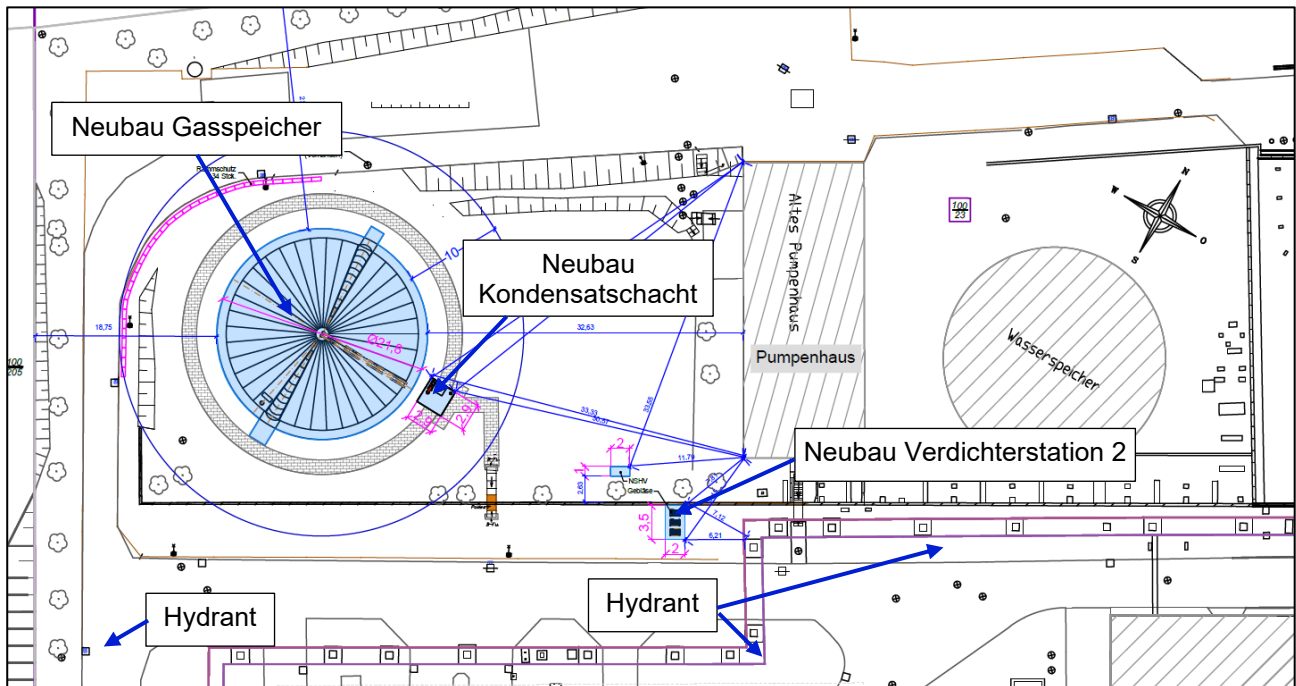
Aufstellplan der geplanten baulichen Anlagen mit Bemaßung von relevanten Abständen, Quelle: [U9]
